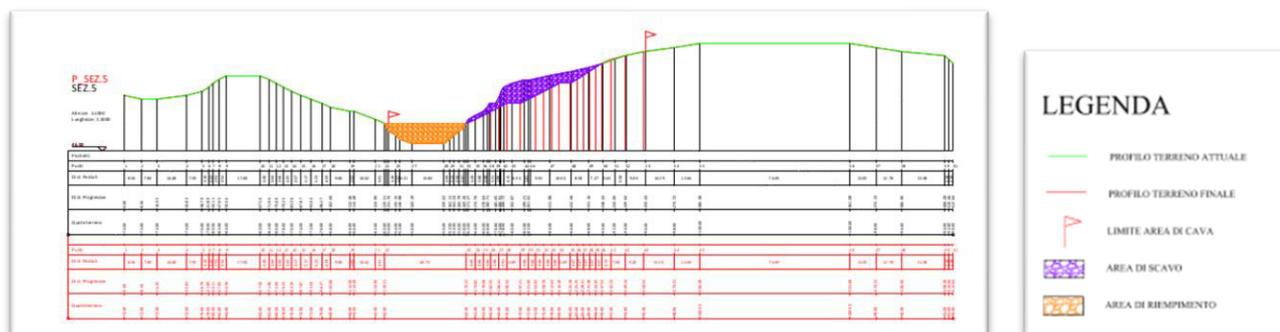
Rappresentazione esemplificativa delle sezioni di progetto allo stadio finale
